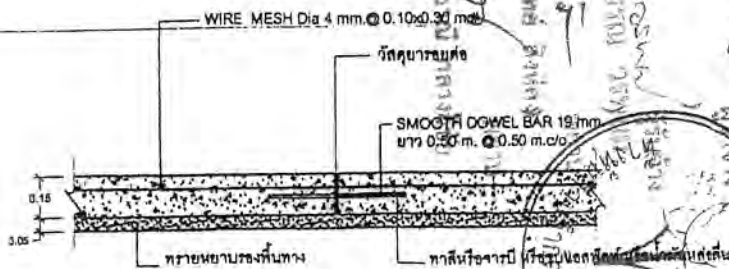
DETAIL. CONSTRUCTION JOINT (รอยต่อเพื่อการก่อสร้าง)
